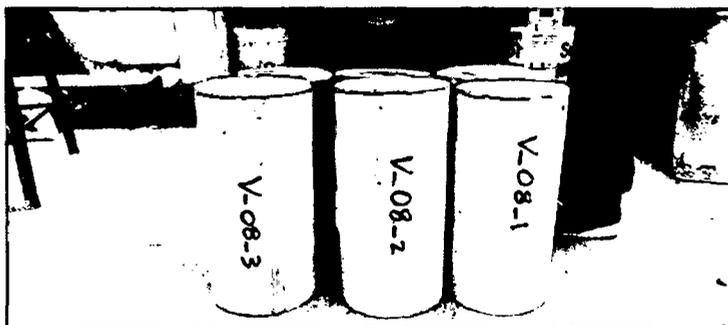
Transporte de muestras cilíndricas de concreto hecho al pie de obra hacia lo zona de curado.
